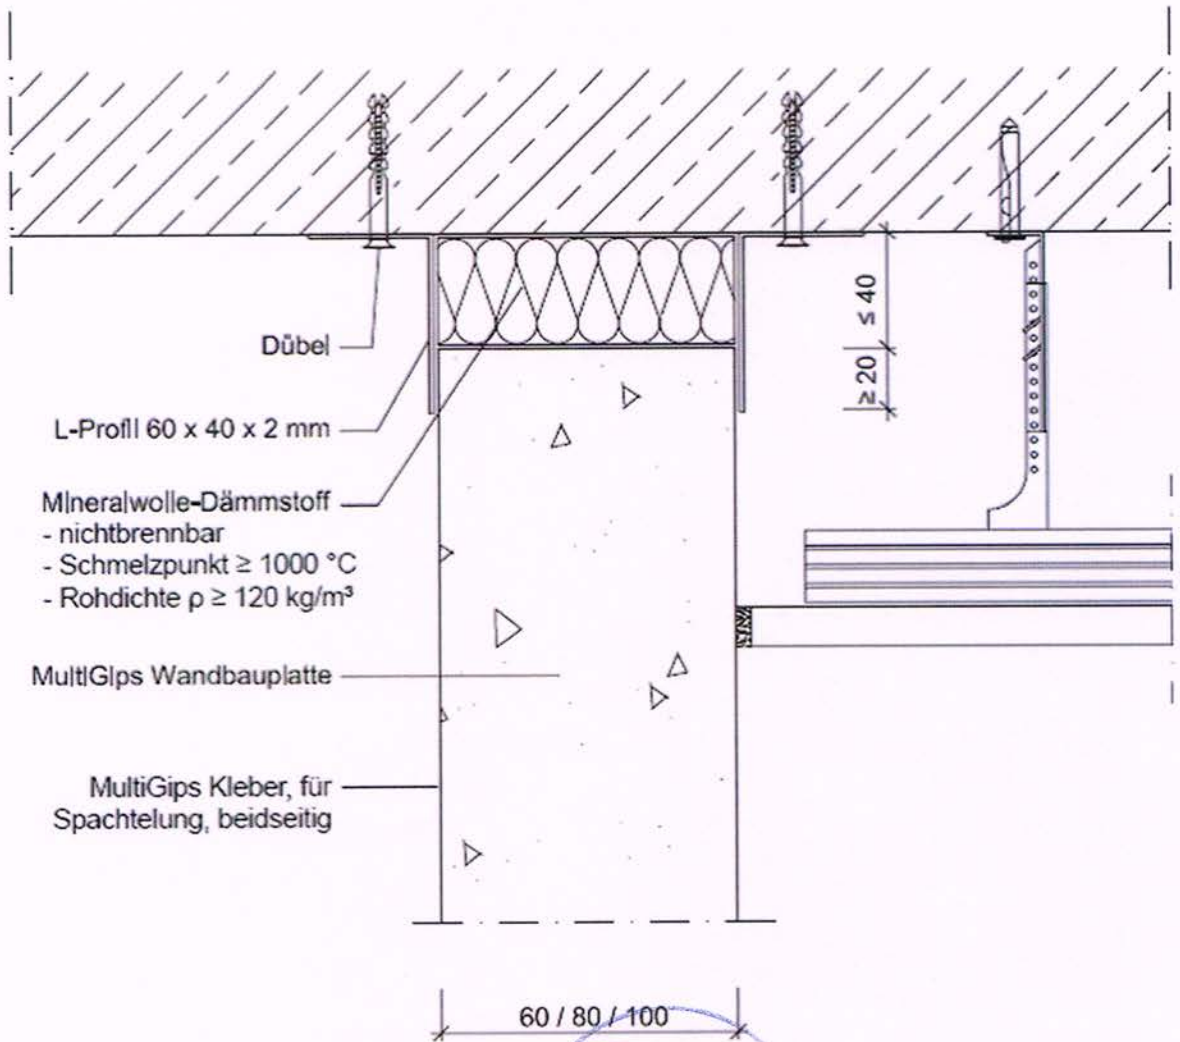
Gleitender Deckenanschluss – Variante 2
